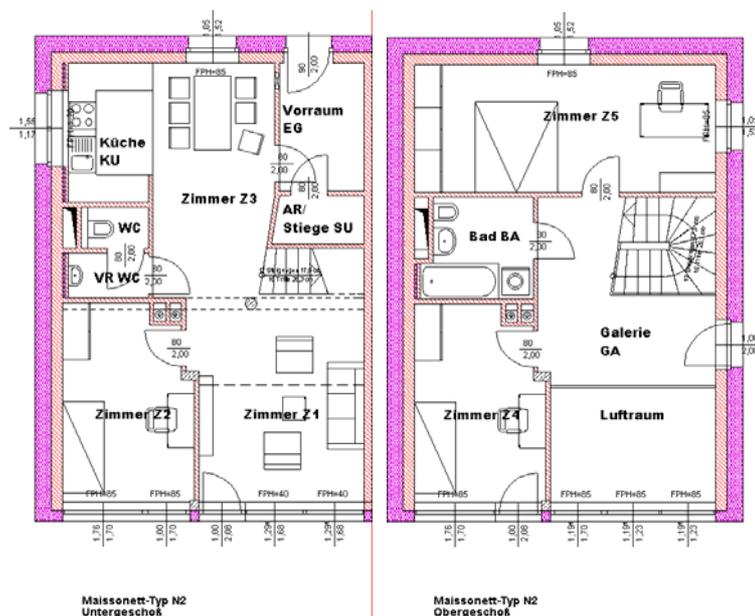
Grundriß des Maisonette-Typs N2 (Untergeschoss links, Obergeschoss rechts)
